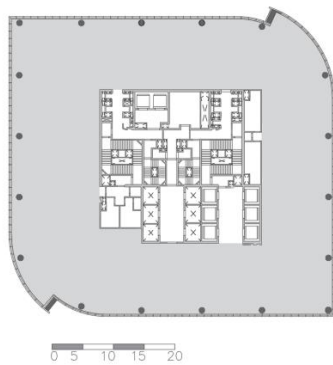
Planta tipo das Torres A e B do complexo São Paulo Corporate. Fonte: a partir de ARCHDAILY, 2016, s/p.
